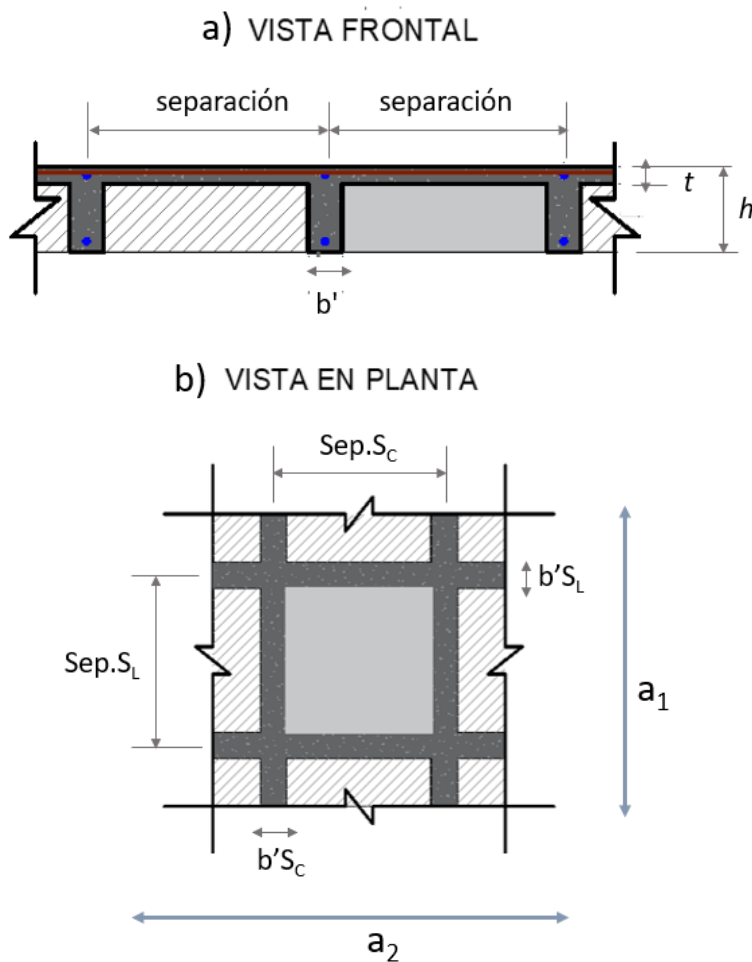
Características de las losas aligeradas en dos direcciones a) vista frontal b) vista en planta.
